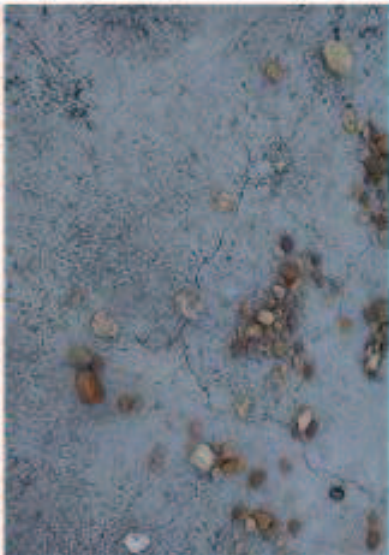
Vista superior del acceso de la pile 8 al viaducto con conservas en los accesos A y B
